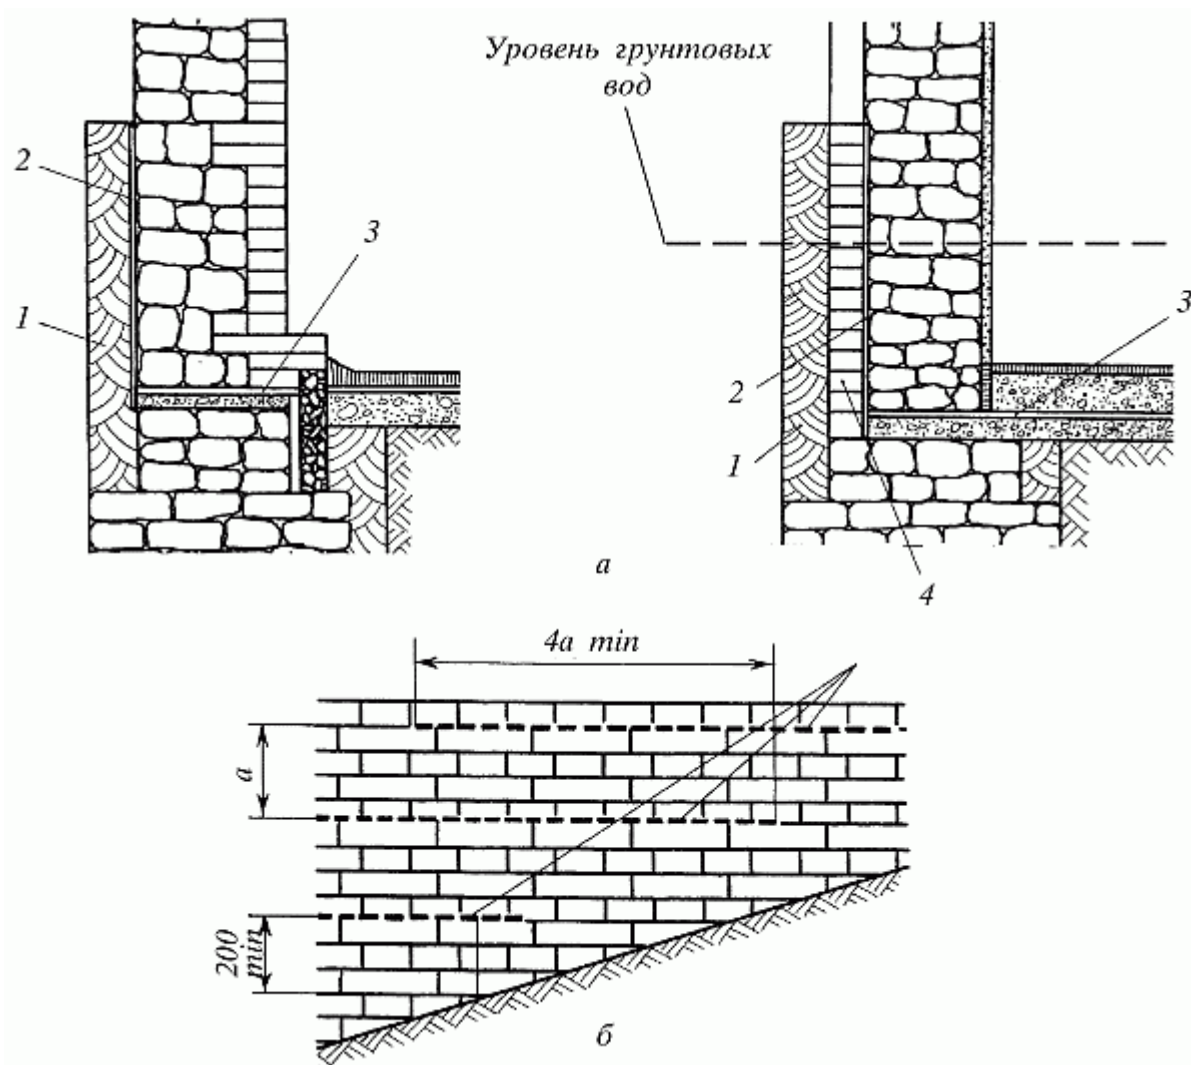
Гидроизоляция фундаментов: а – вертикальная; б – горизонтальная; 1 – глиняный замок; 2 – оклеечная изоляция; 3 – горизонтальная изоляция; 4 – прижимная стенка
